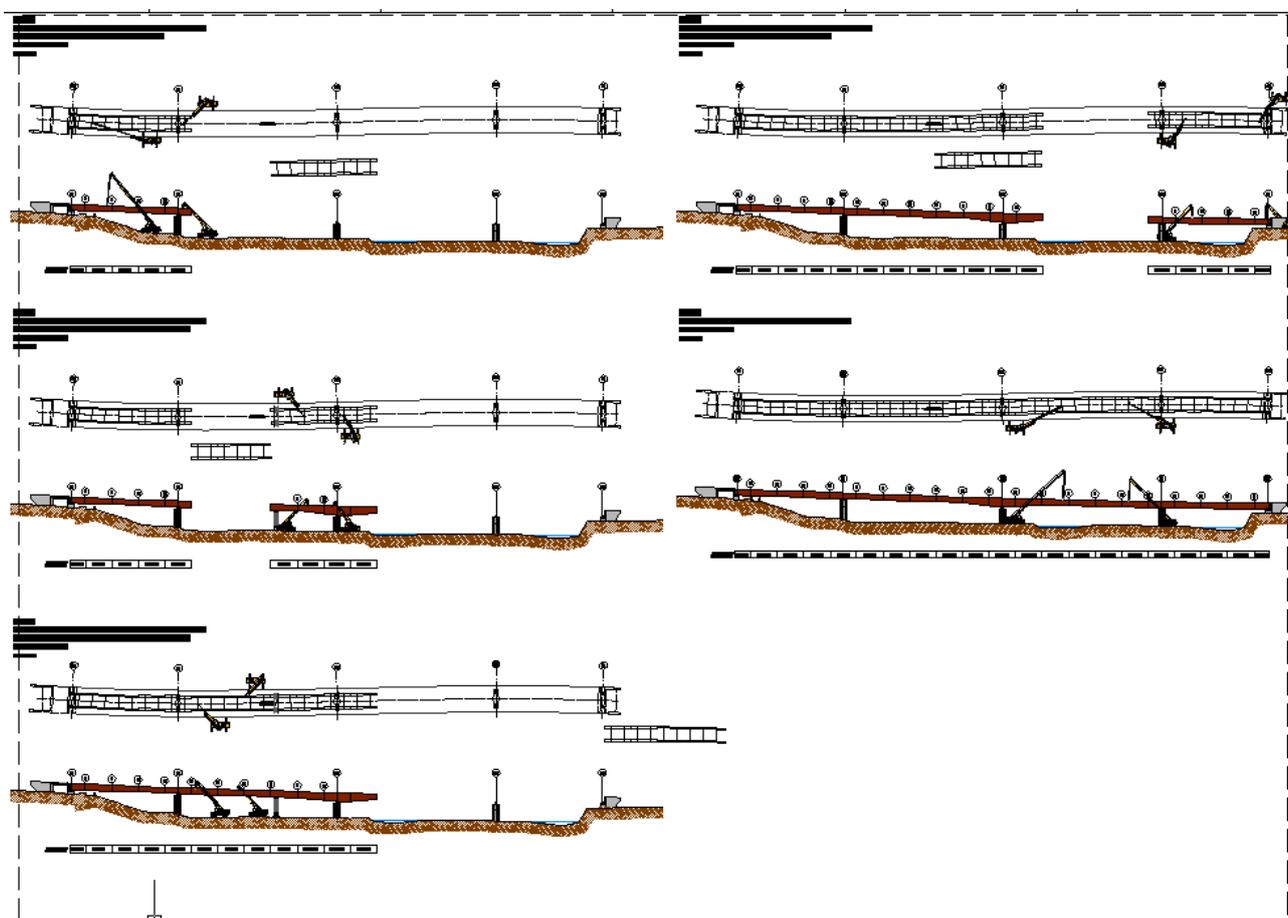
Montaggio Viadotto Ellero – LAYOUT cantiere
